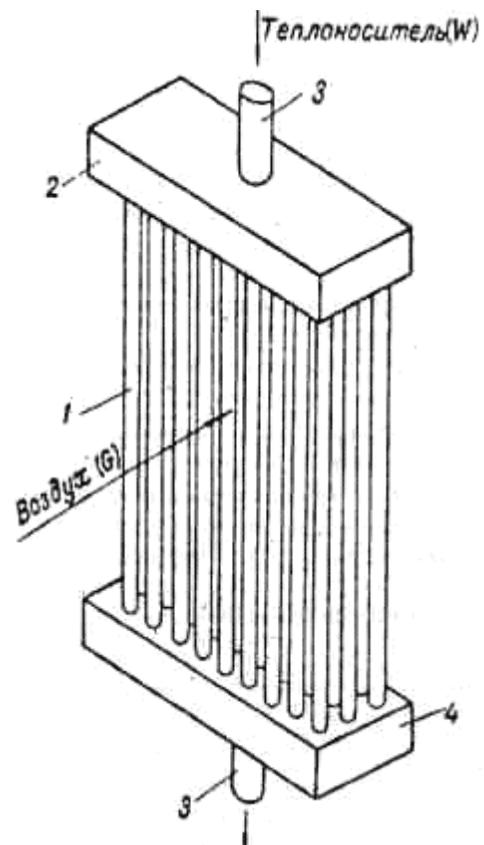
Схема конструкции калориферов: 1 — трубы; 2 — распределительная коробка; 3 — подводящий и отводящий трубопроводы; 4 — сборная коробка.
